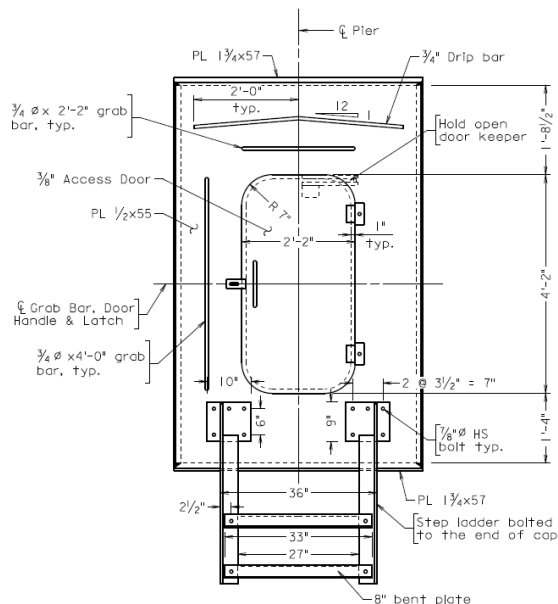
Detalles de la puerta del cajón de un pórtico metálico
